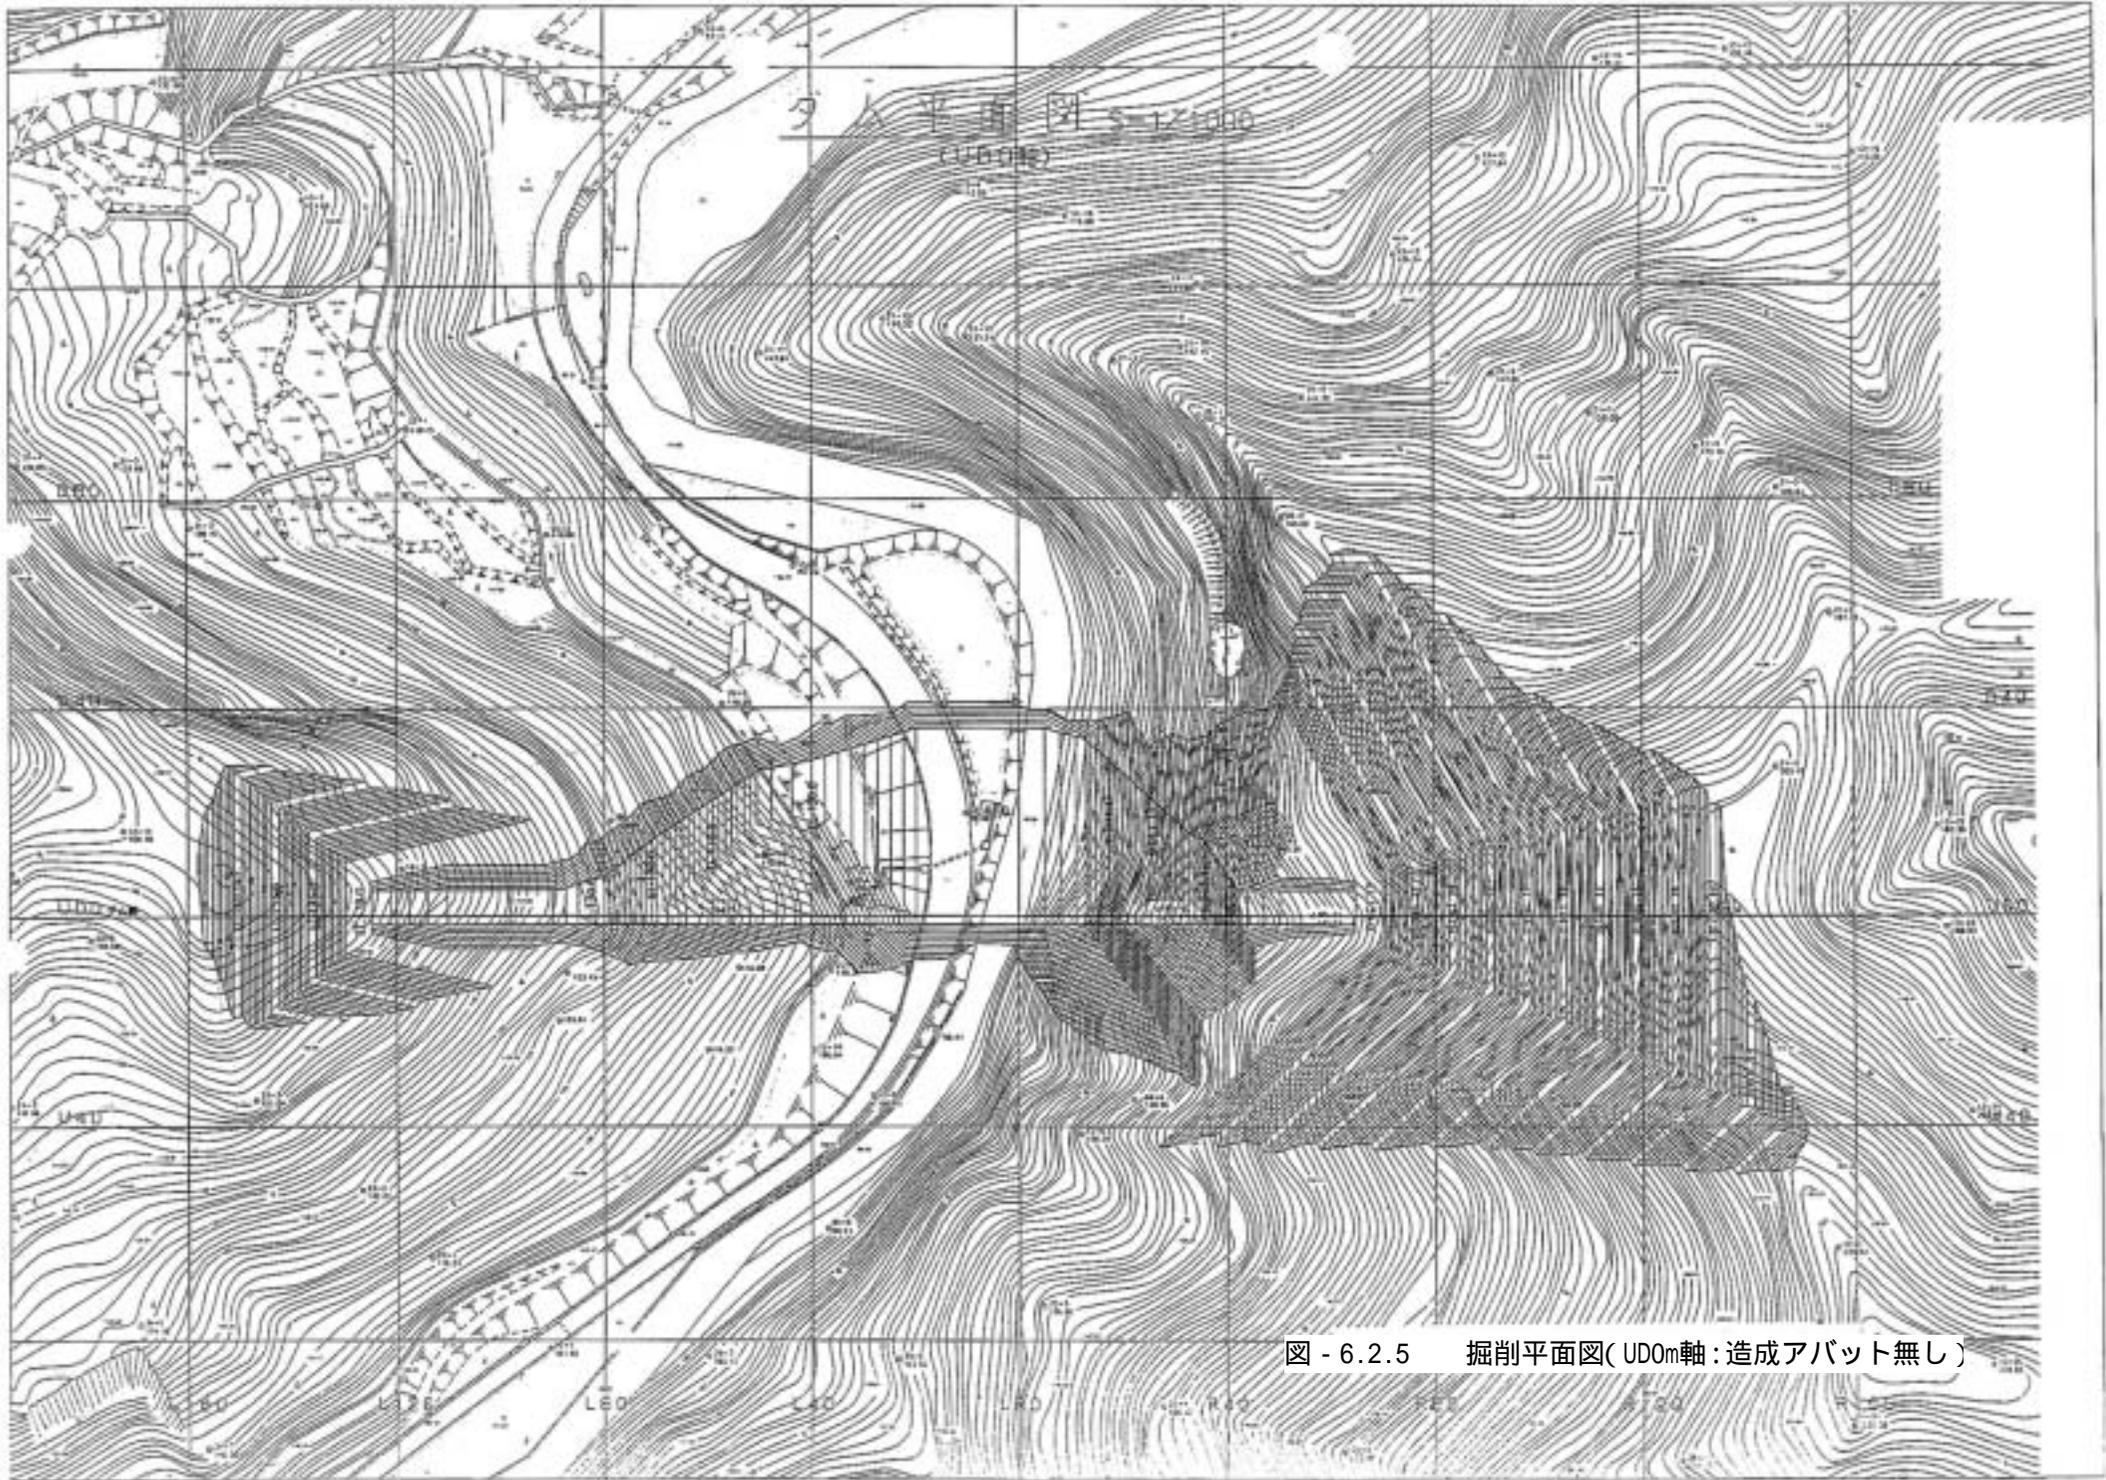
掘削平面図(UD0m軸:造成アバット無し)
